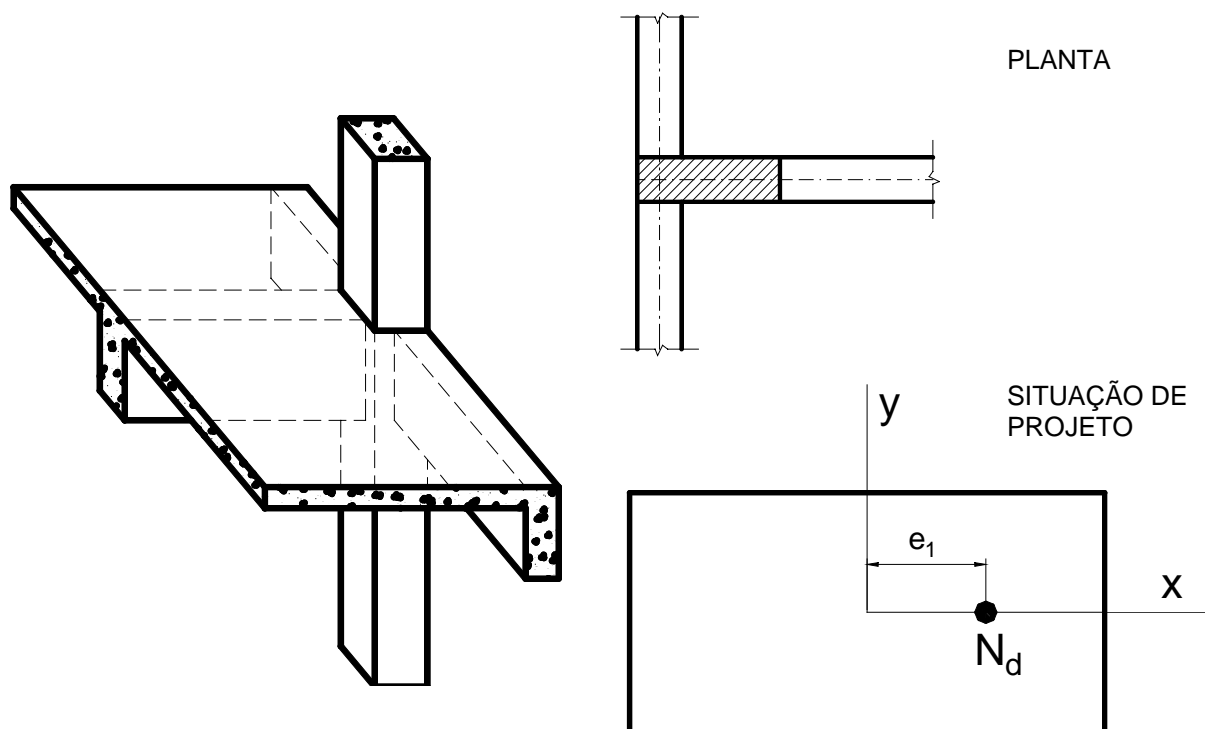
Arranjo estrutural e situação de projeto dos pilares de extremidade.
